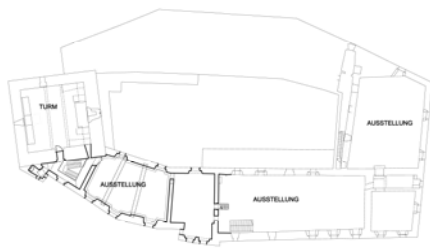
Schloss Bruck, Grundriss, 1. Obergeschoss
